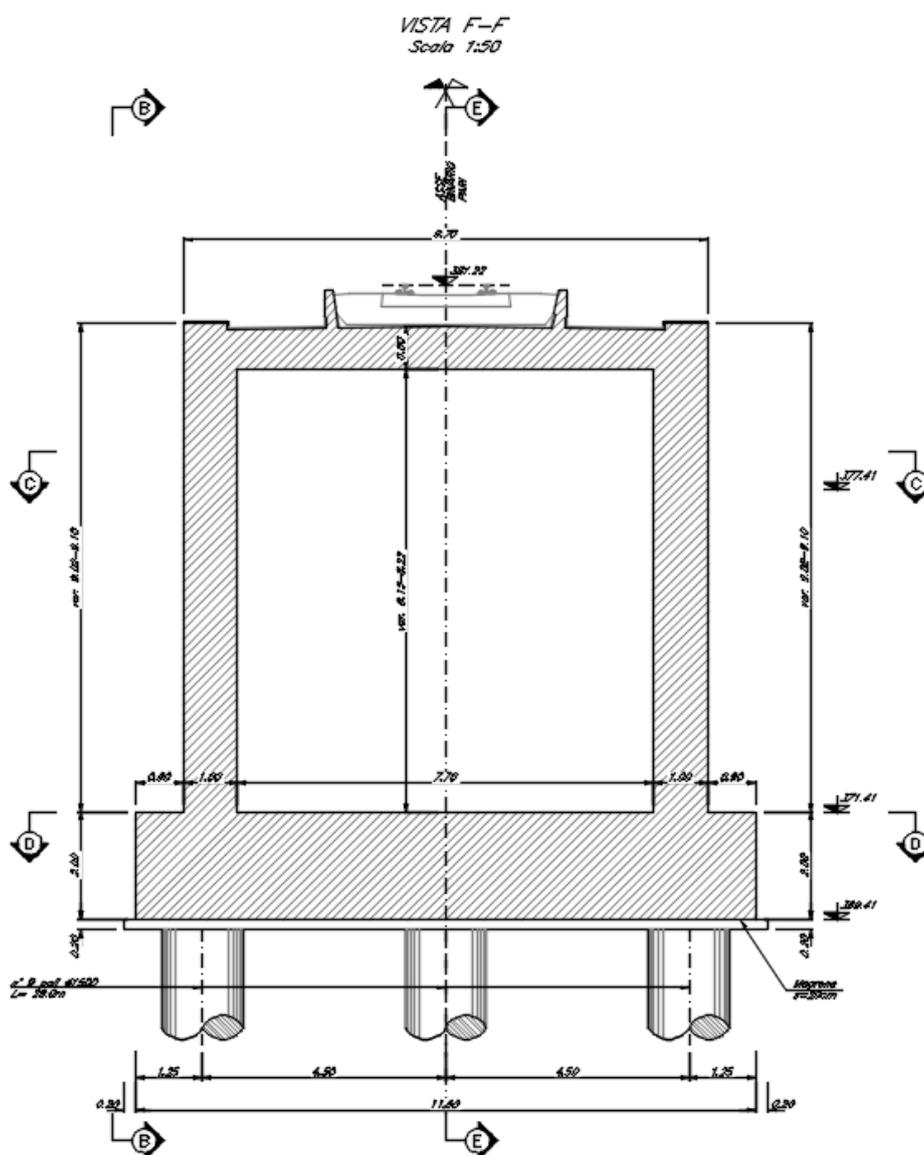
Dettaglio sezione trasversale spalla B
